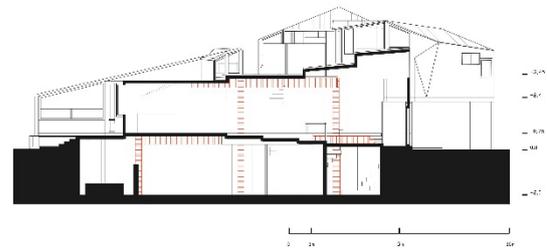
Corte rampa-galería de la casa Cruz. Elaboración propia
